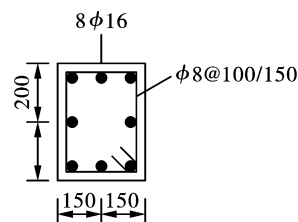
钢筋混凝土柱截面配筋图(单位:mm)
